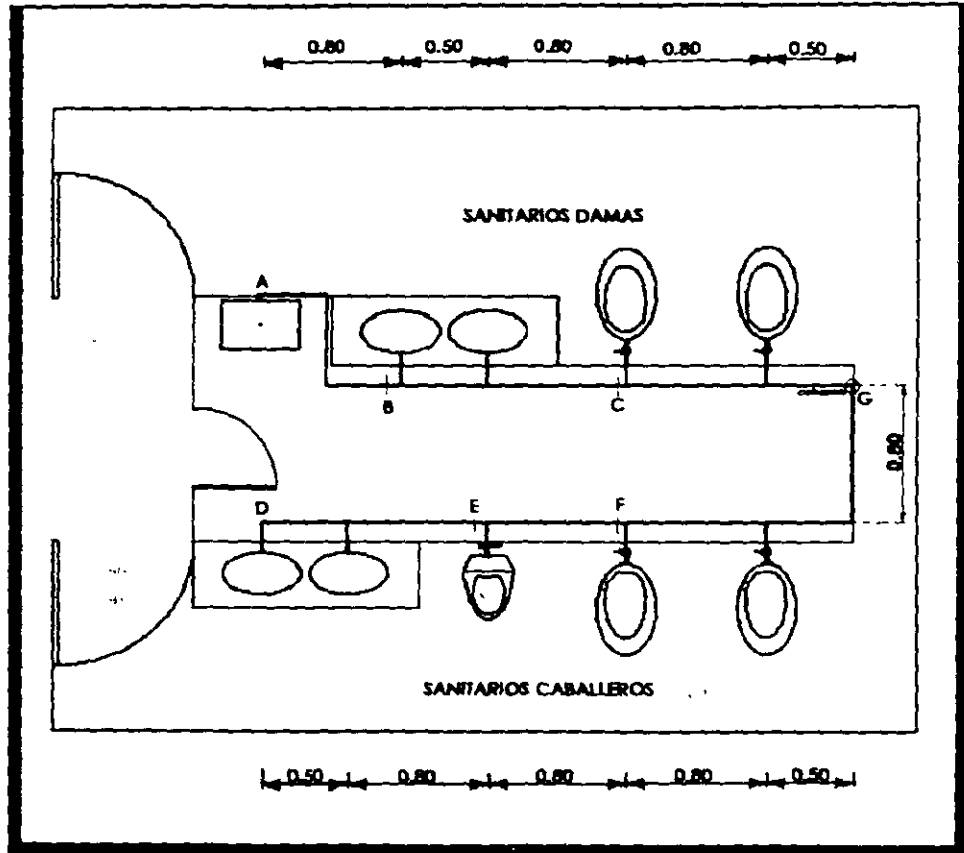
Planta arquitectónica de los sanitarios de un edificio.
